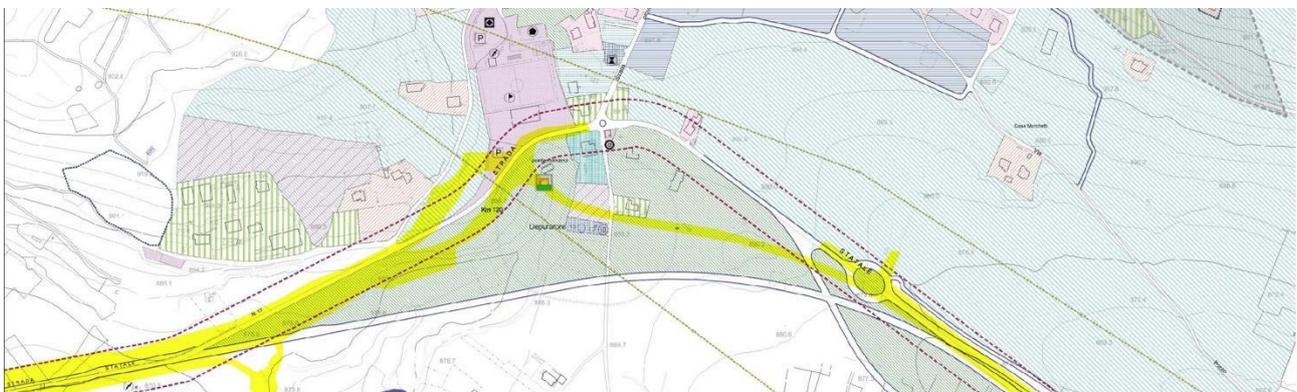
Sovrapposizione tracciato di progetto (in giallo) e stralcio tav. P2a – Zonizzazione in ambito urbano Barisciano centro
